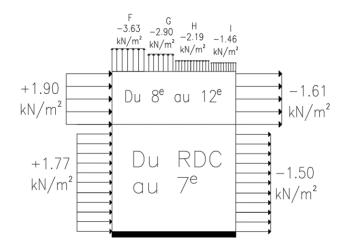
Valeurs des pressions W(zj) sur la construction en direction (V1)
